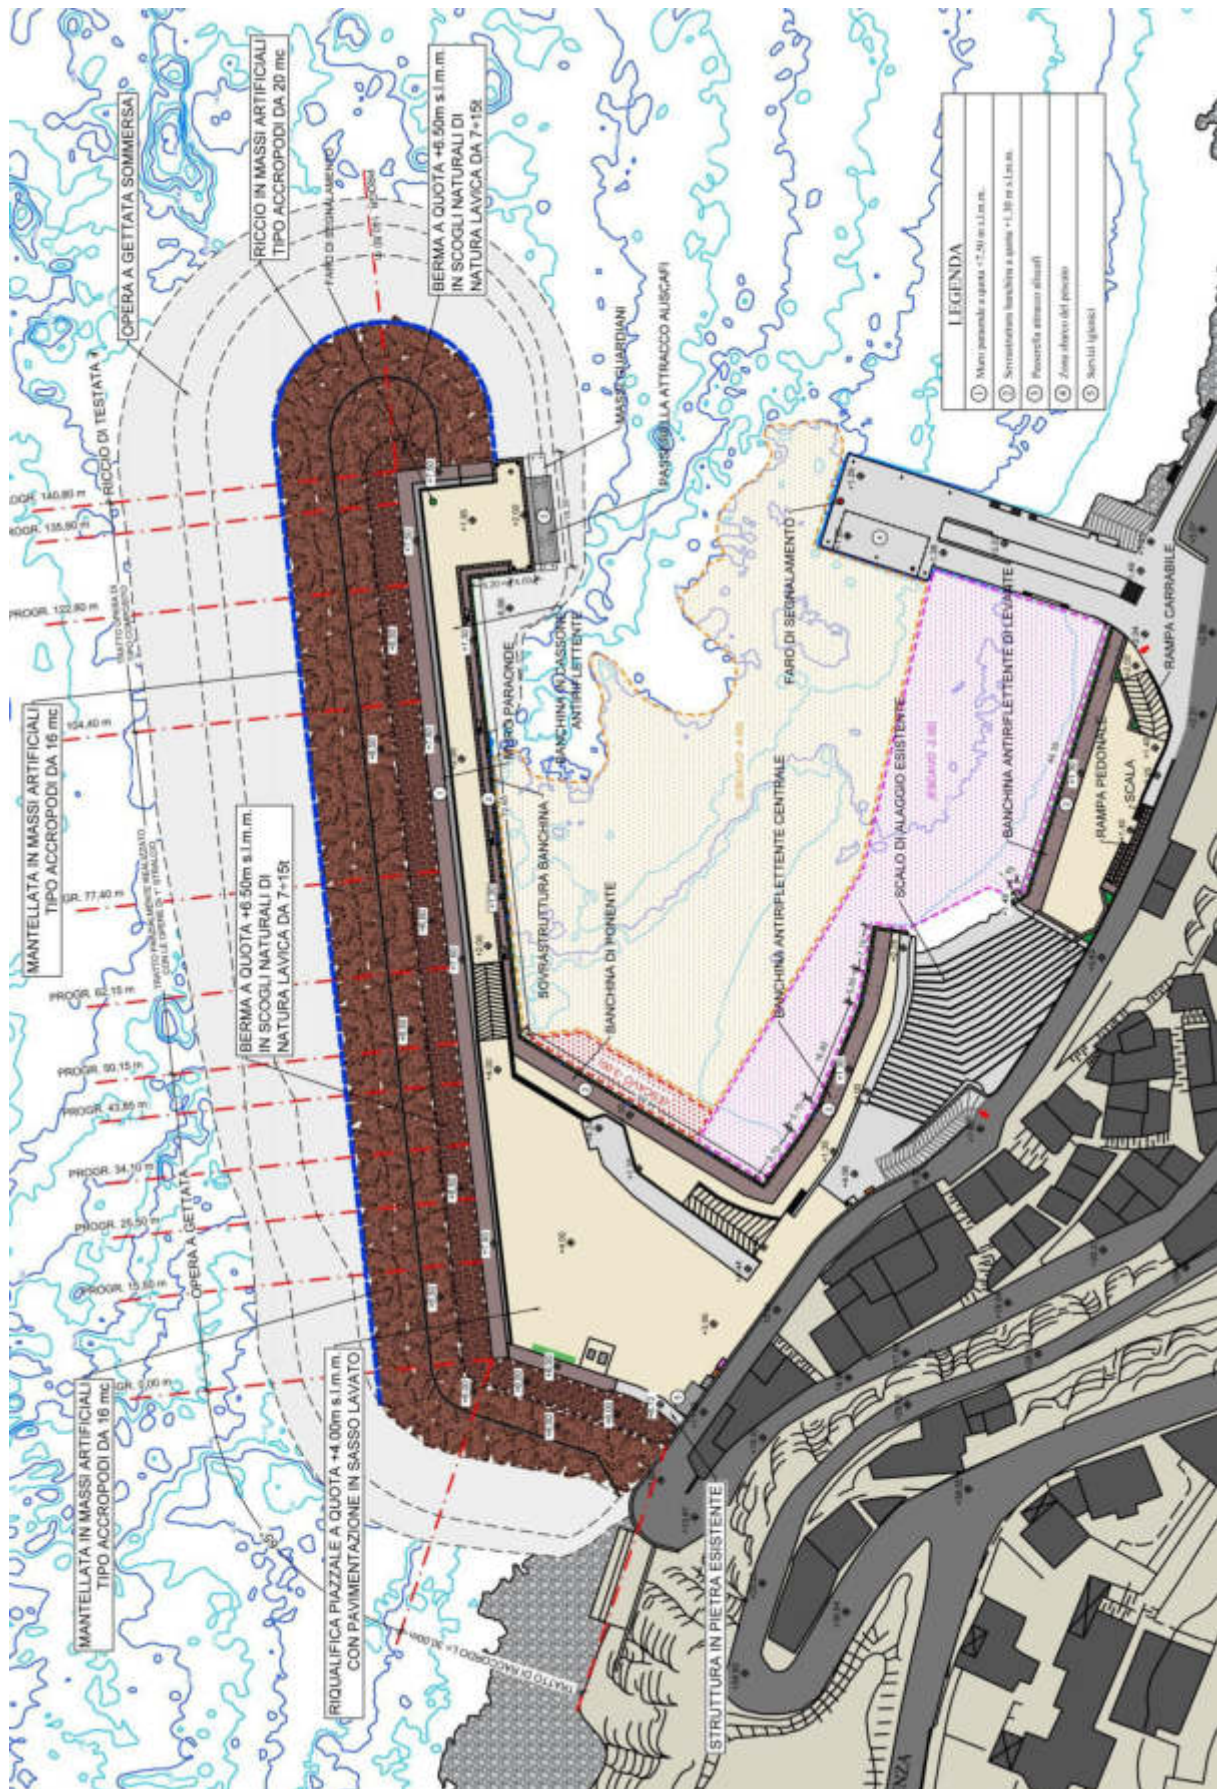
Planimetria con indicazione delle opere del progetto di riunione
